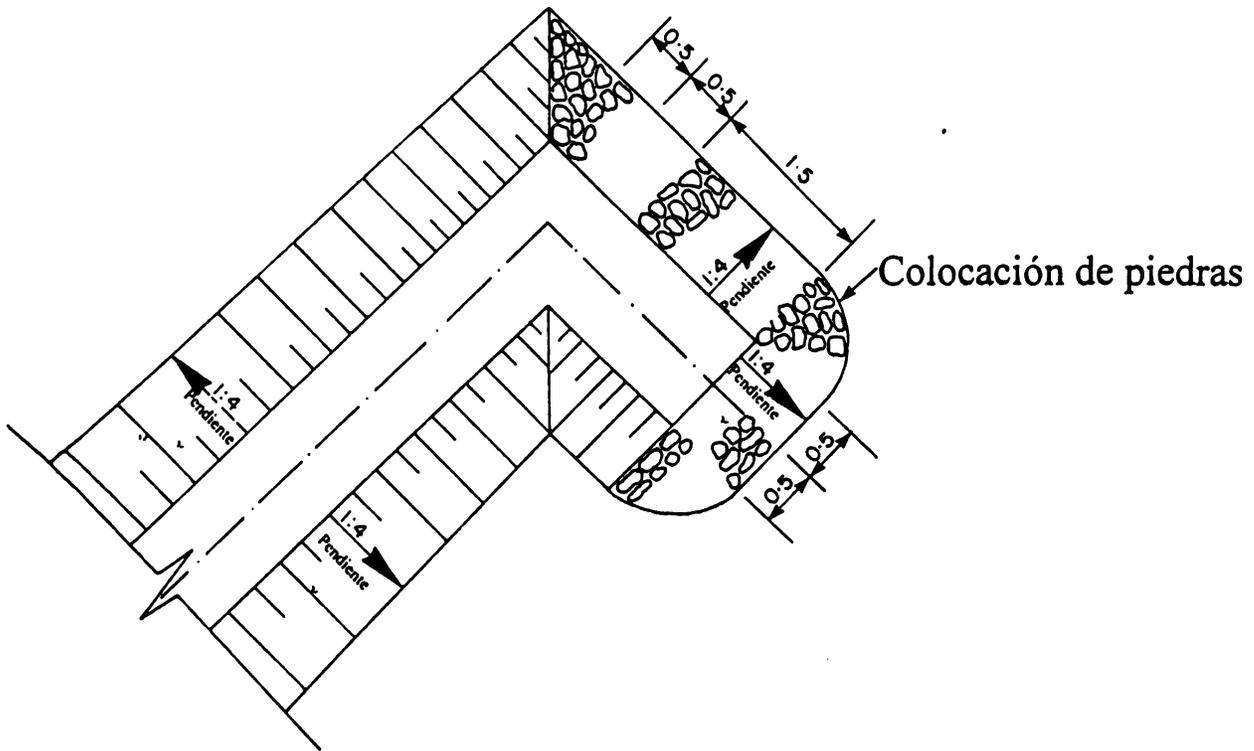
Bordos Trapezoidales: Detalle del vertedero.
